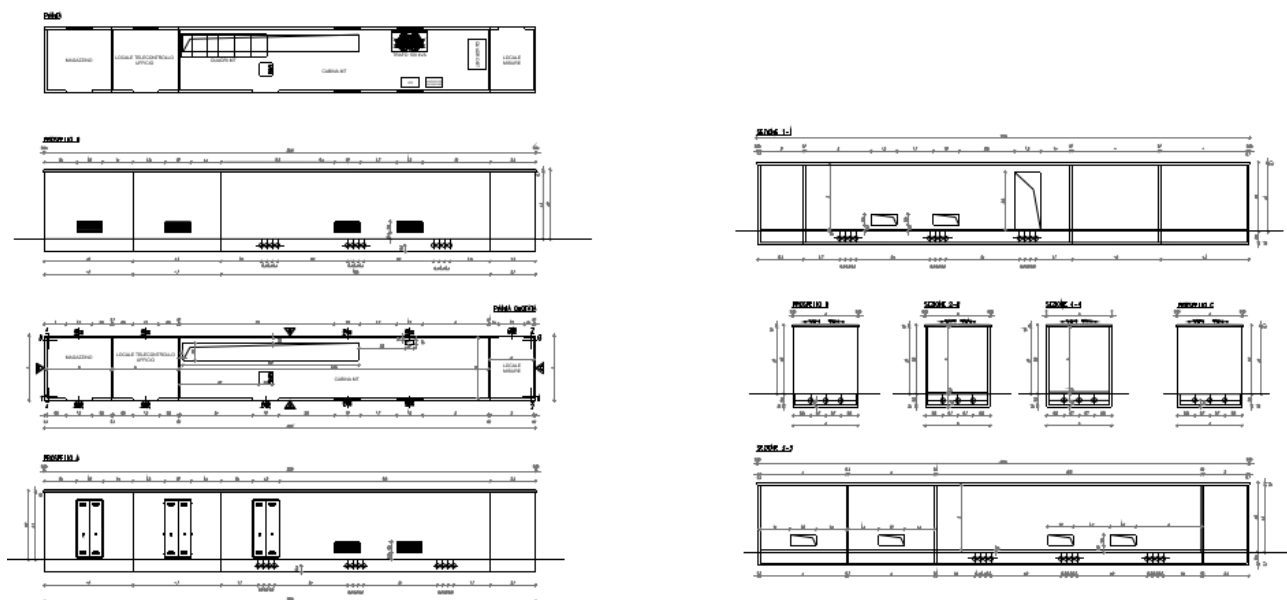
Pianta, prospetti e Sezioni della Sottostazione Utente
